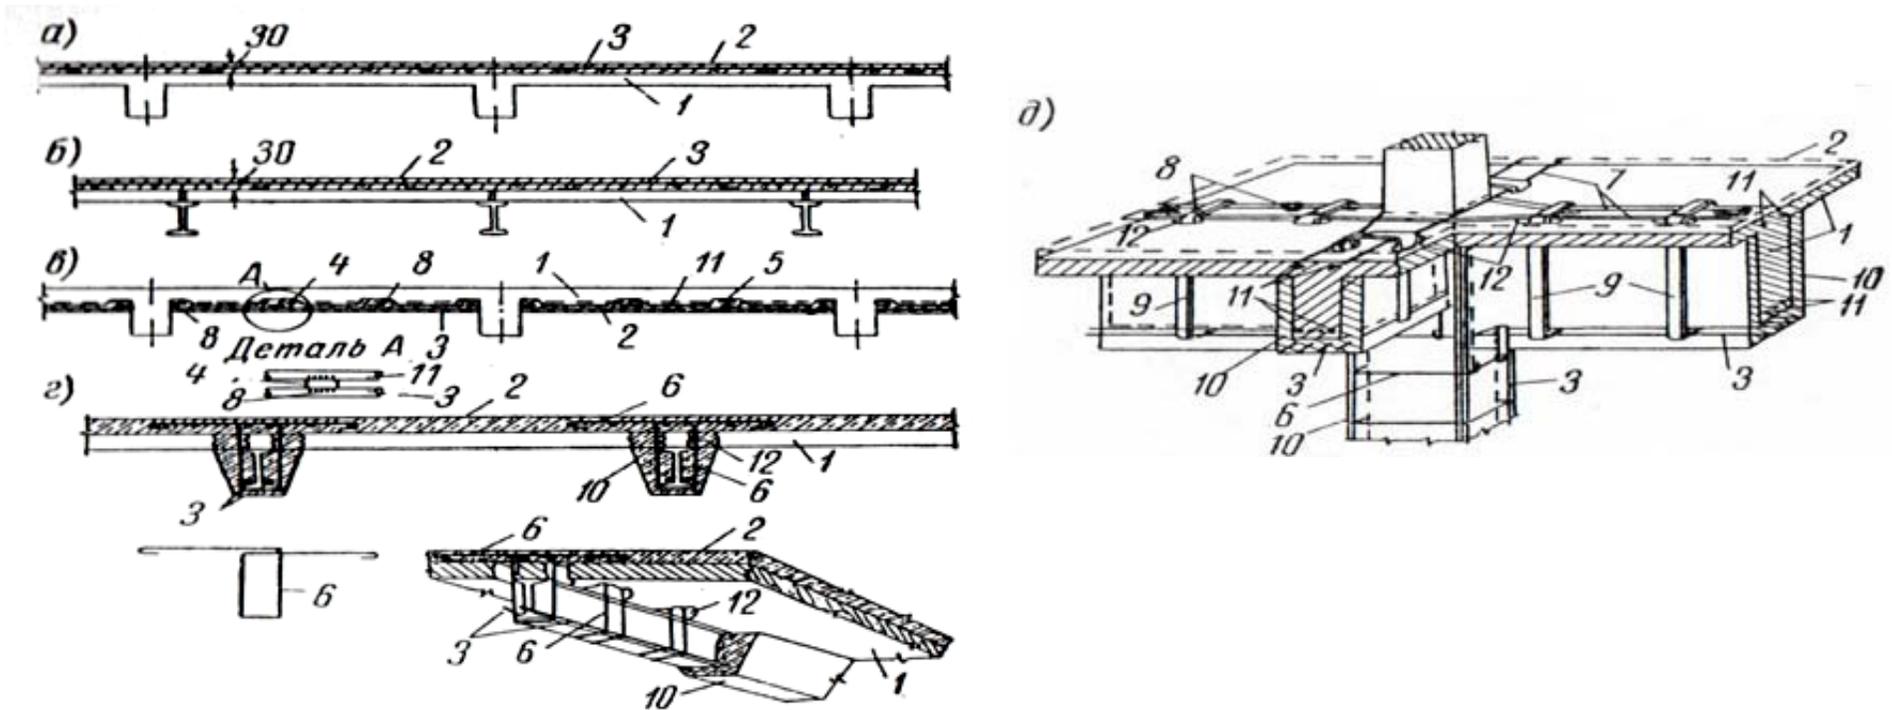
Конструкции усиления плит ребристых перекрытий наращиванием и обоями:
